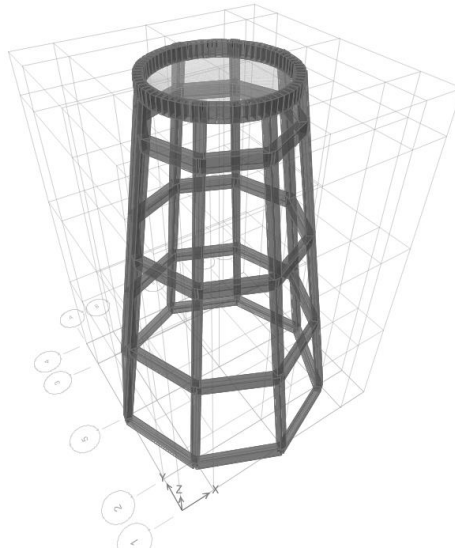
Modelado de la torre de hormigón armado con ETabs
